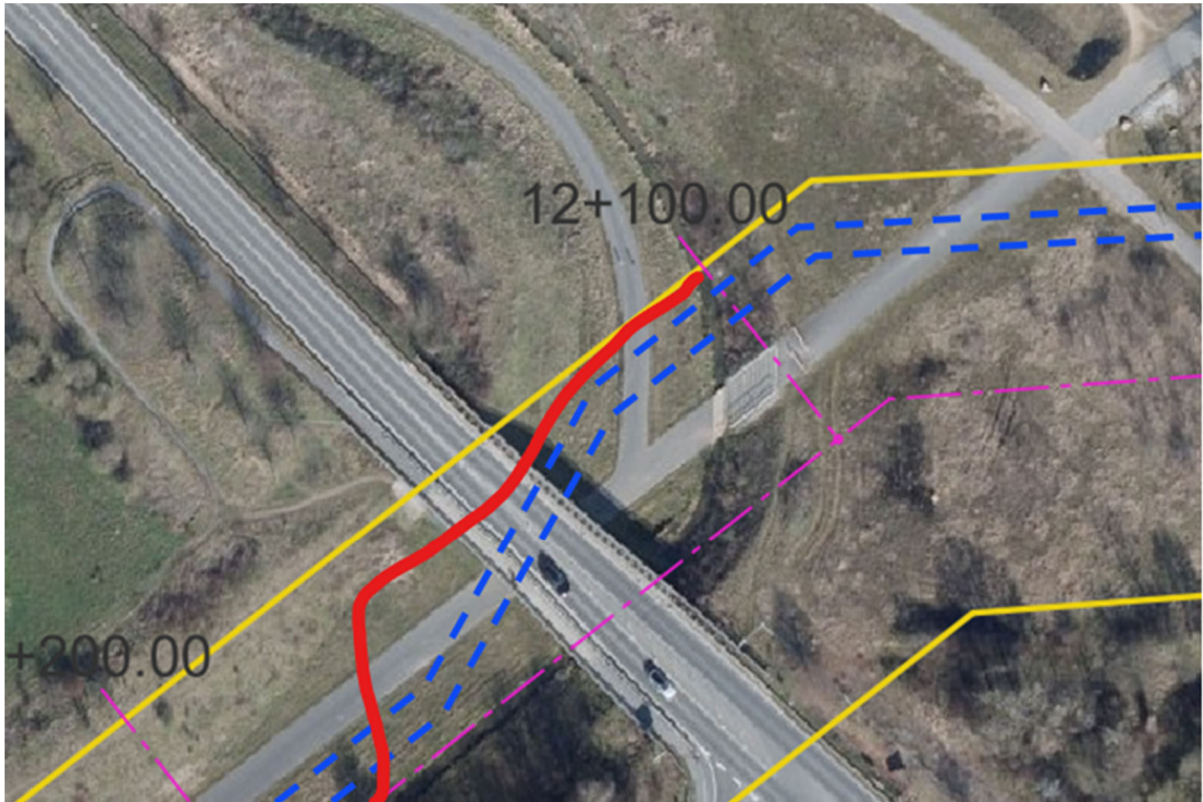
Techn. Gewässer, Speedway, Lageplan, offene Querung
